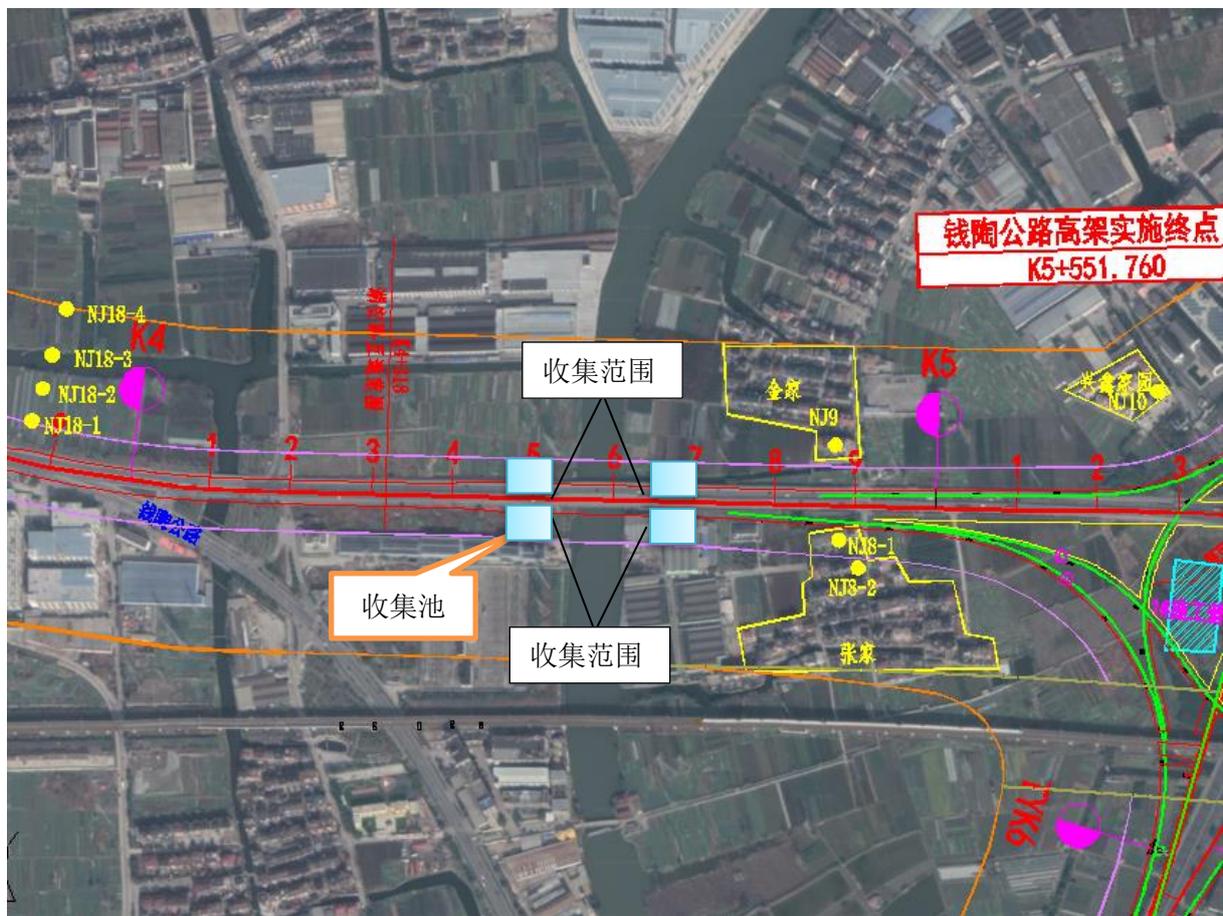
项目钱陶公路高架主线桥跨越东小江收集系统平面布置图
